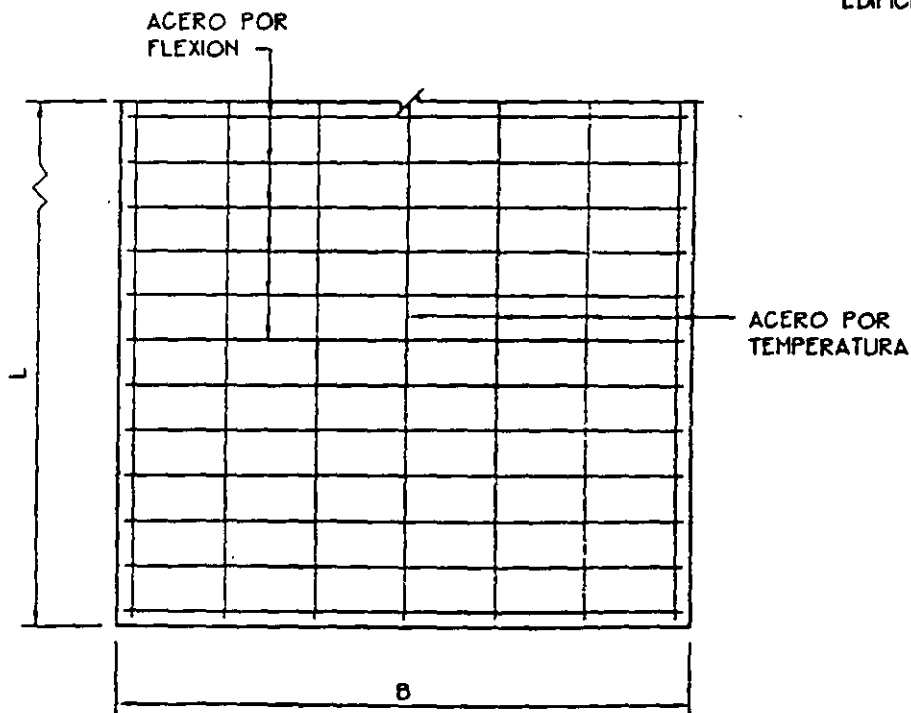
DISPOSICION DEL ACERO DE REFUERZO EN UNA ZAPATA CORRIDA.
